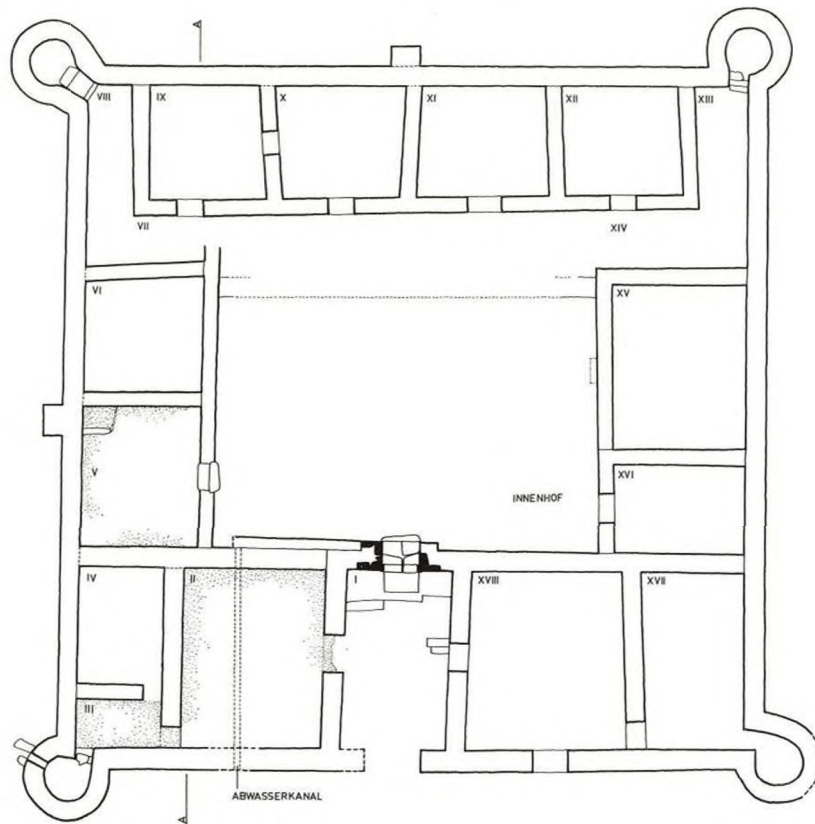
Grundriß von Bau „D“. (B. LAUTER)
